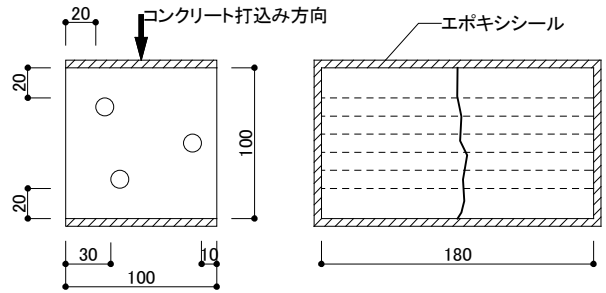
貫通ひび割れ試験体(試験体タイプA)
